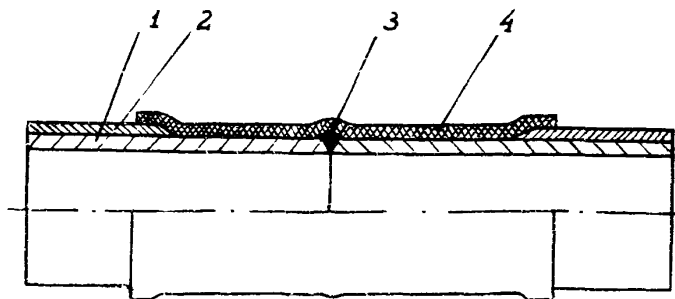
Изоляция сварного стыка термоусадочными муфтами:
